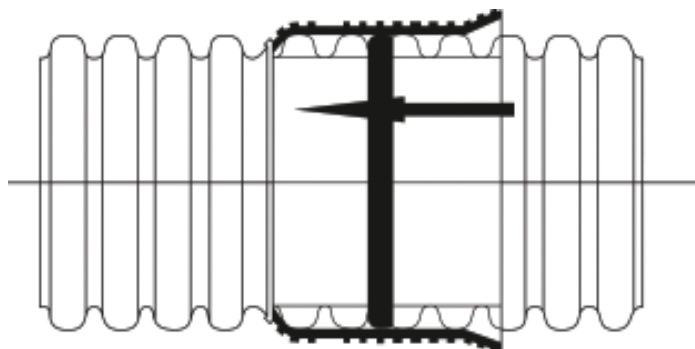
Схема соединения труб с помощью уплотнительного кольца
